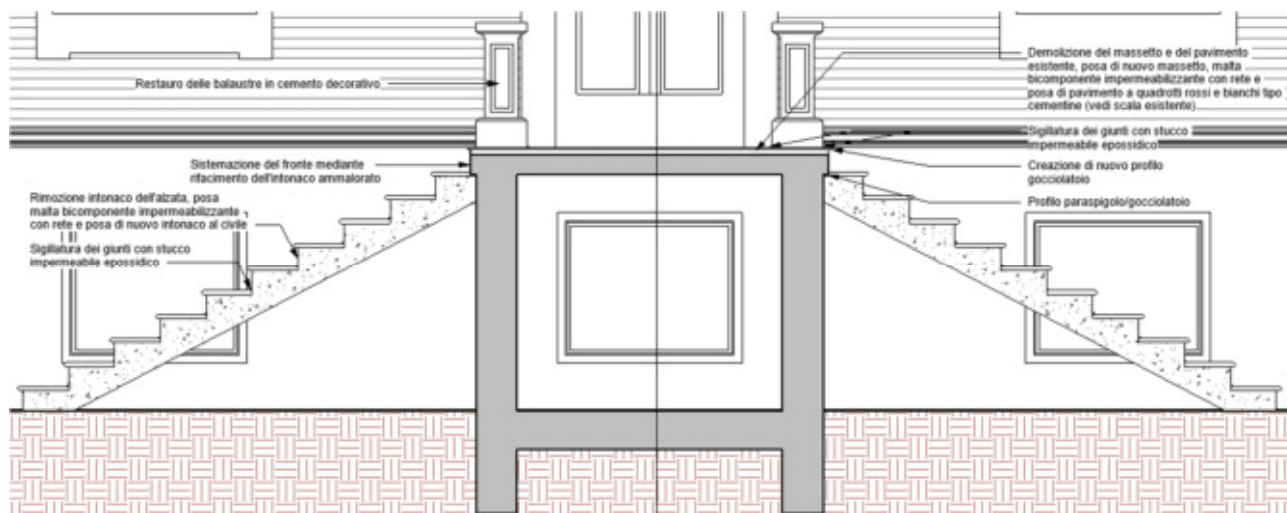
Restauro conservativo delle scale esterne 01 – Sezione A
